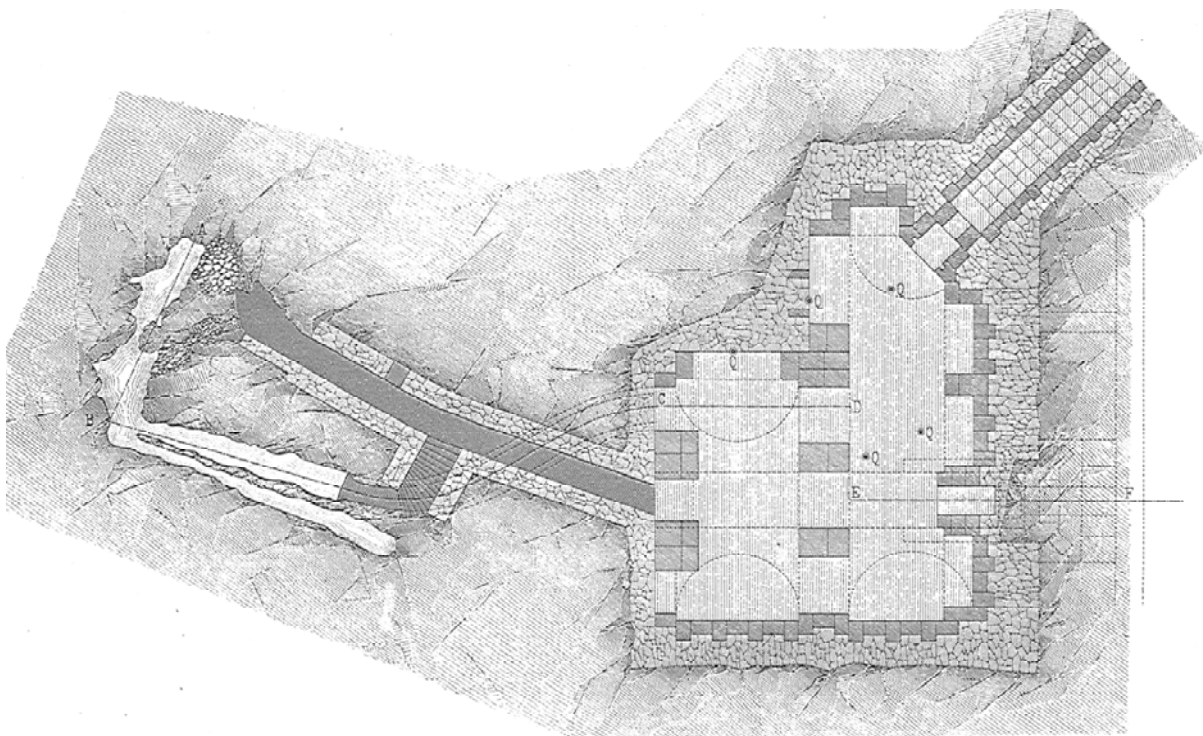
Grundriss des Wasserschlosses Kaiserbrunn
